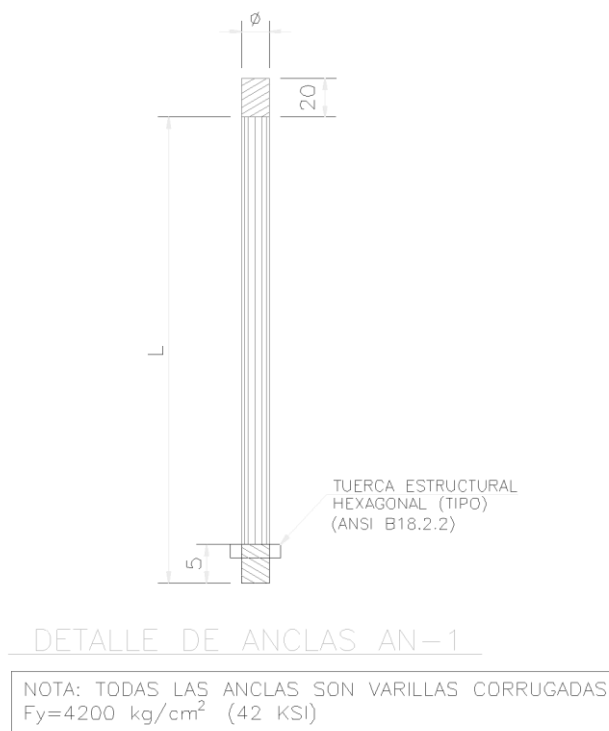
Detalle para las anclas de placa base y estructura metálica que quedarán ahogadas en los dados de las zapatas.
